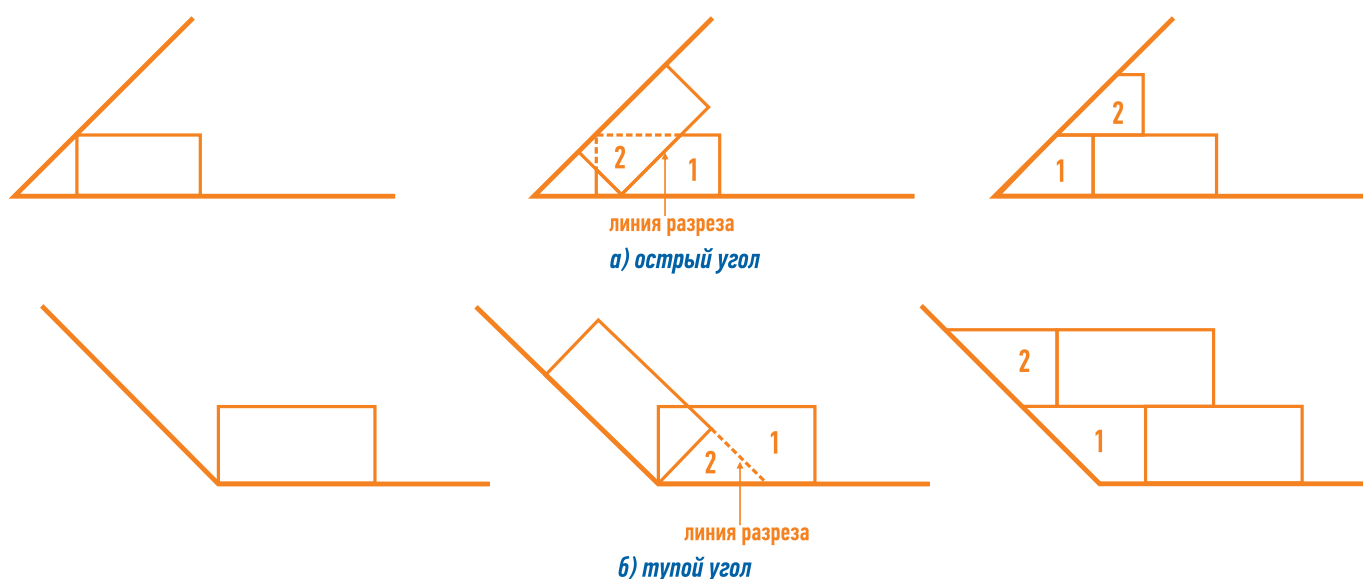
Раскрой и укладка теплоизоляционных плит в углах кровли
